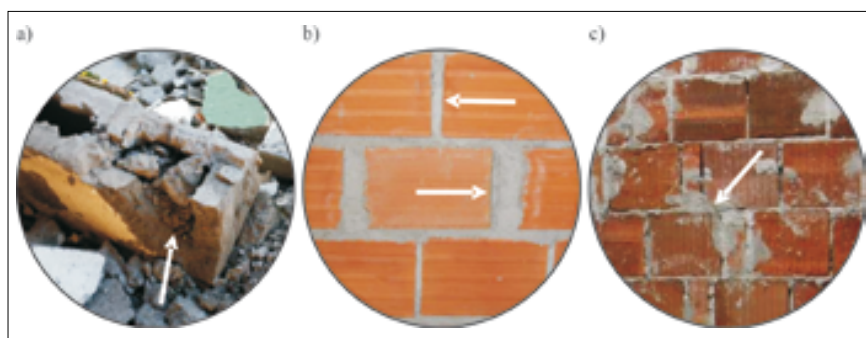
Błędne wykonanie połączenia betonu z murem: a) niedogęszczenie betonu w strzępiach, b) nieregularne wykonanie strzępi [9], c) brak elementów łączących mur z elementem krępującym
